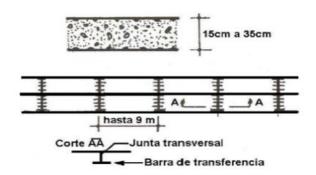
Pavimento de concreto simple con pasadores Nota: Alicaresp (2019).
